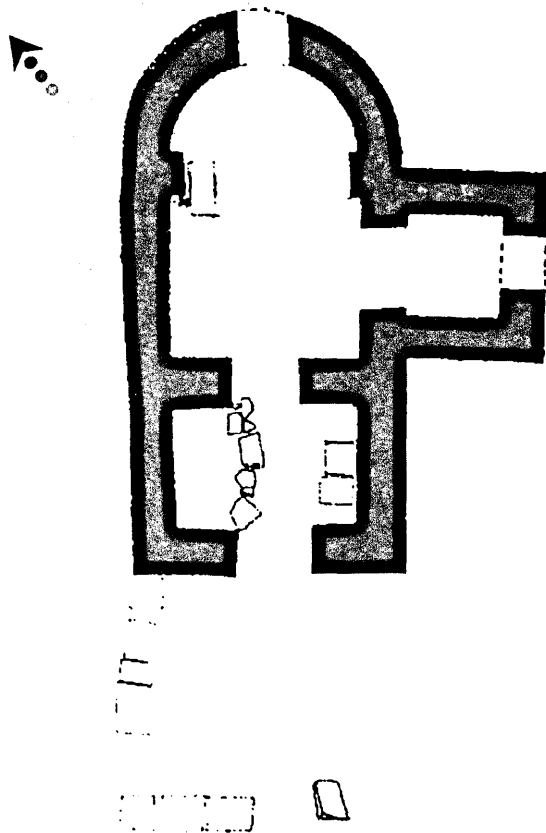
Villasimius. Santa Maria: planimetria (rielaborazione da TRONCHETTI, FANNI 1982).
